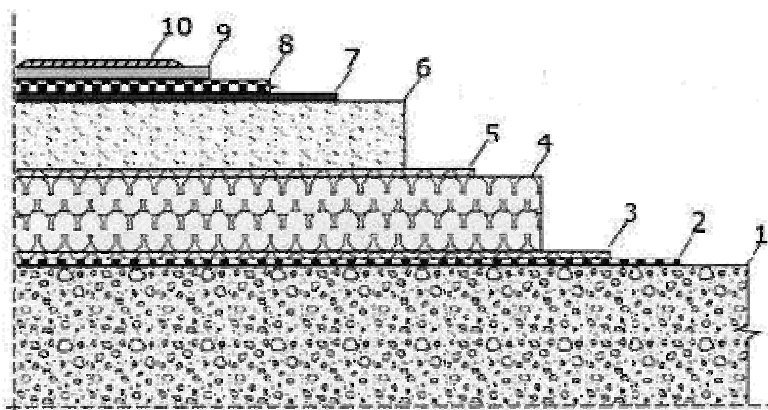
Гідроізоляція тераси із покриттям з кахельною плиткою: 1 – залізобетонна основа; 2 – пароізоляція; 3 – геотекстиль з просоченням; 4 – теплоізоляції; 5 – геотекстиль; 6 – стяжка з різними ухилами; 7 – праймер; 8 – рідка гума; 9 – плитковий клей; 10 – плитка
